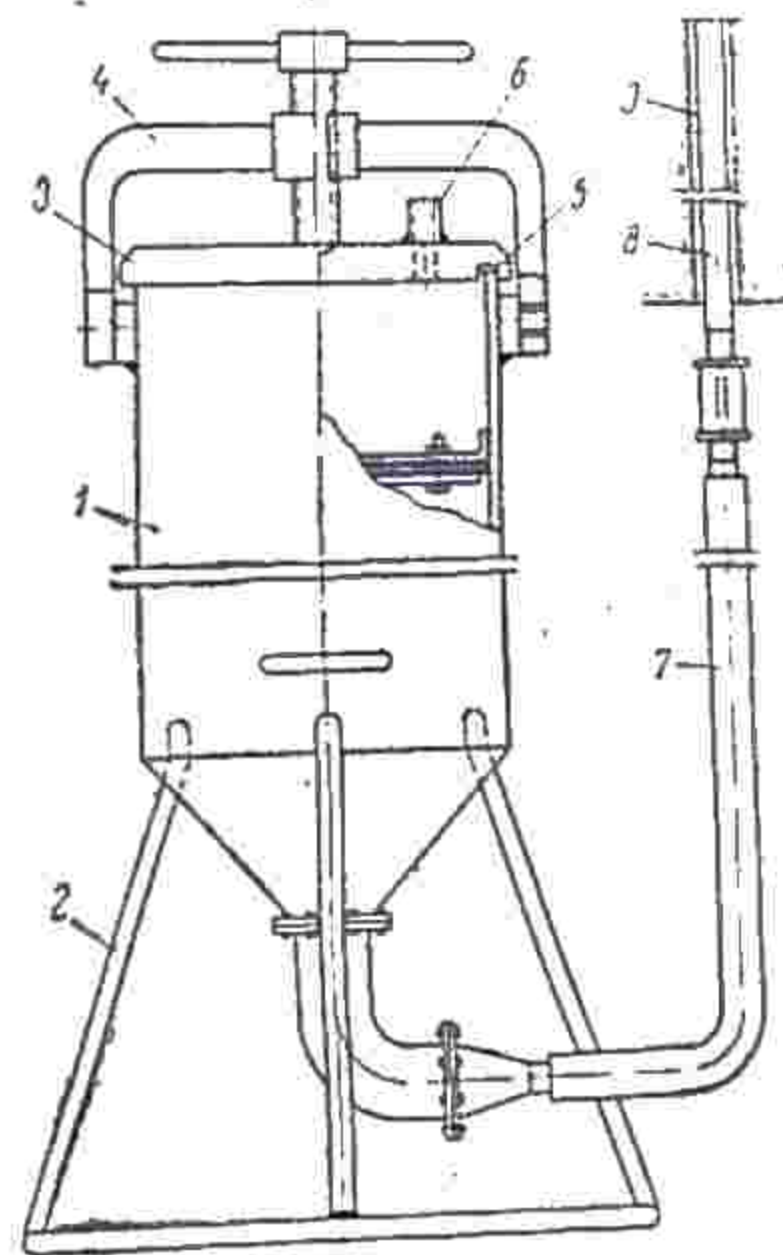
Пневмонагнетатель НИГРИ для установки железобетонных анкеров
